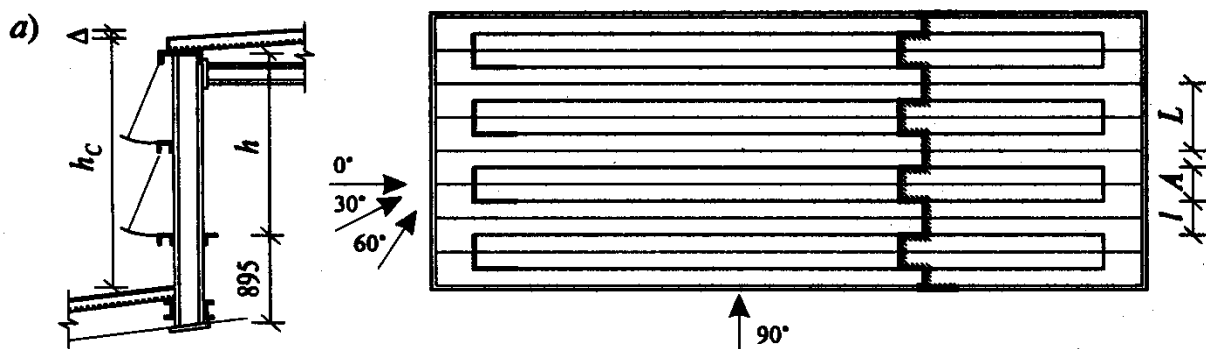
схемы для определения незадуваемости прямоугольных фонарей (разрез по фонарной панели и план покрытия многопролетного здания с фонарями)
